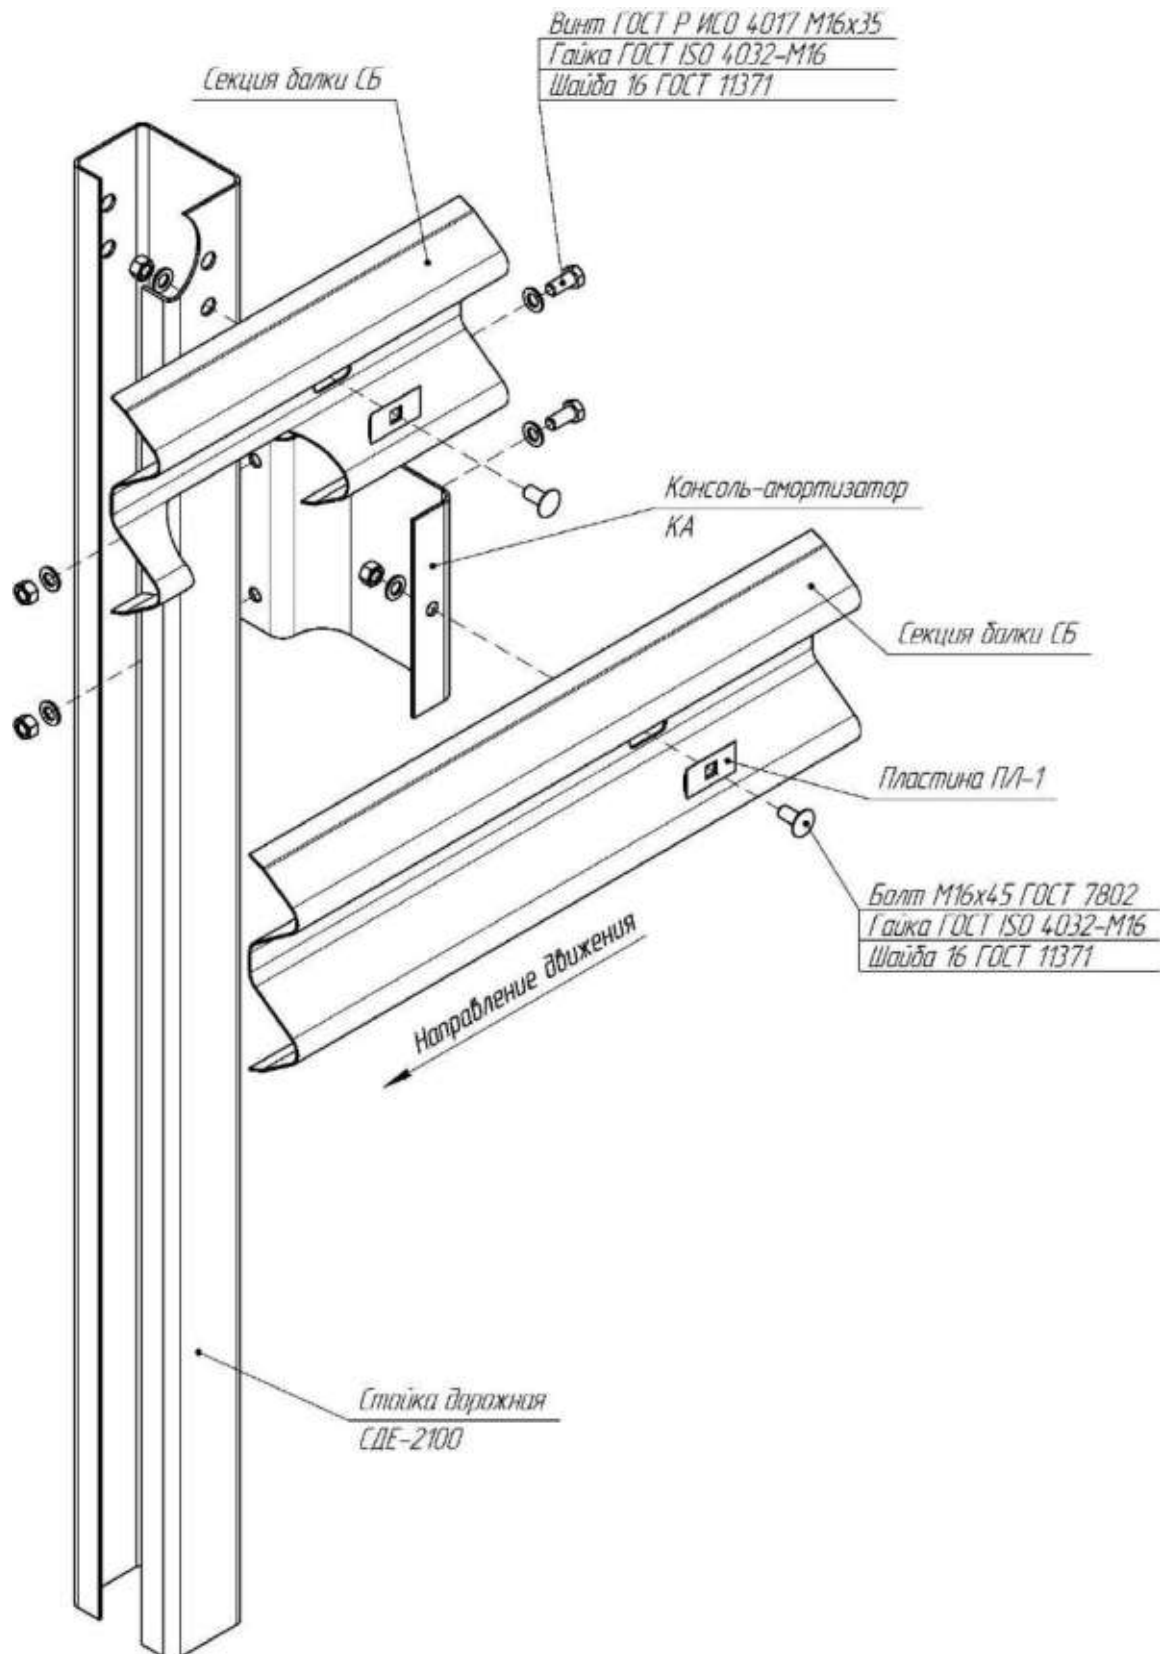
а – Схема сборки конструкции №7 с балкой СБ (Изм. №1)
